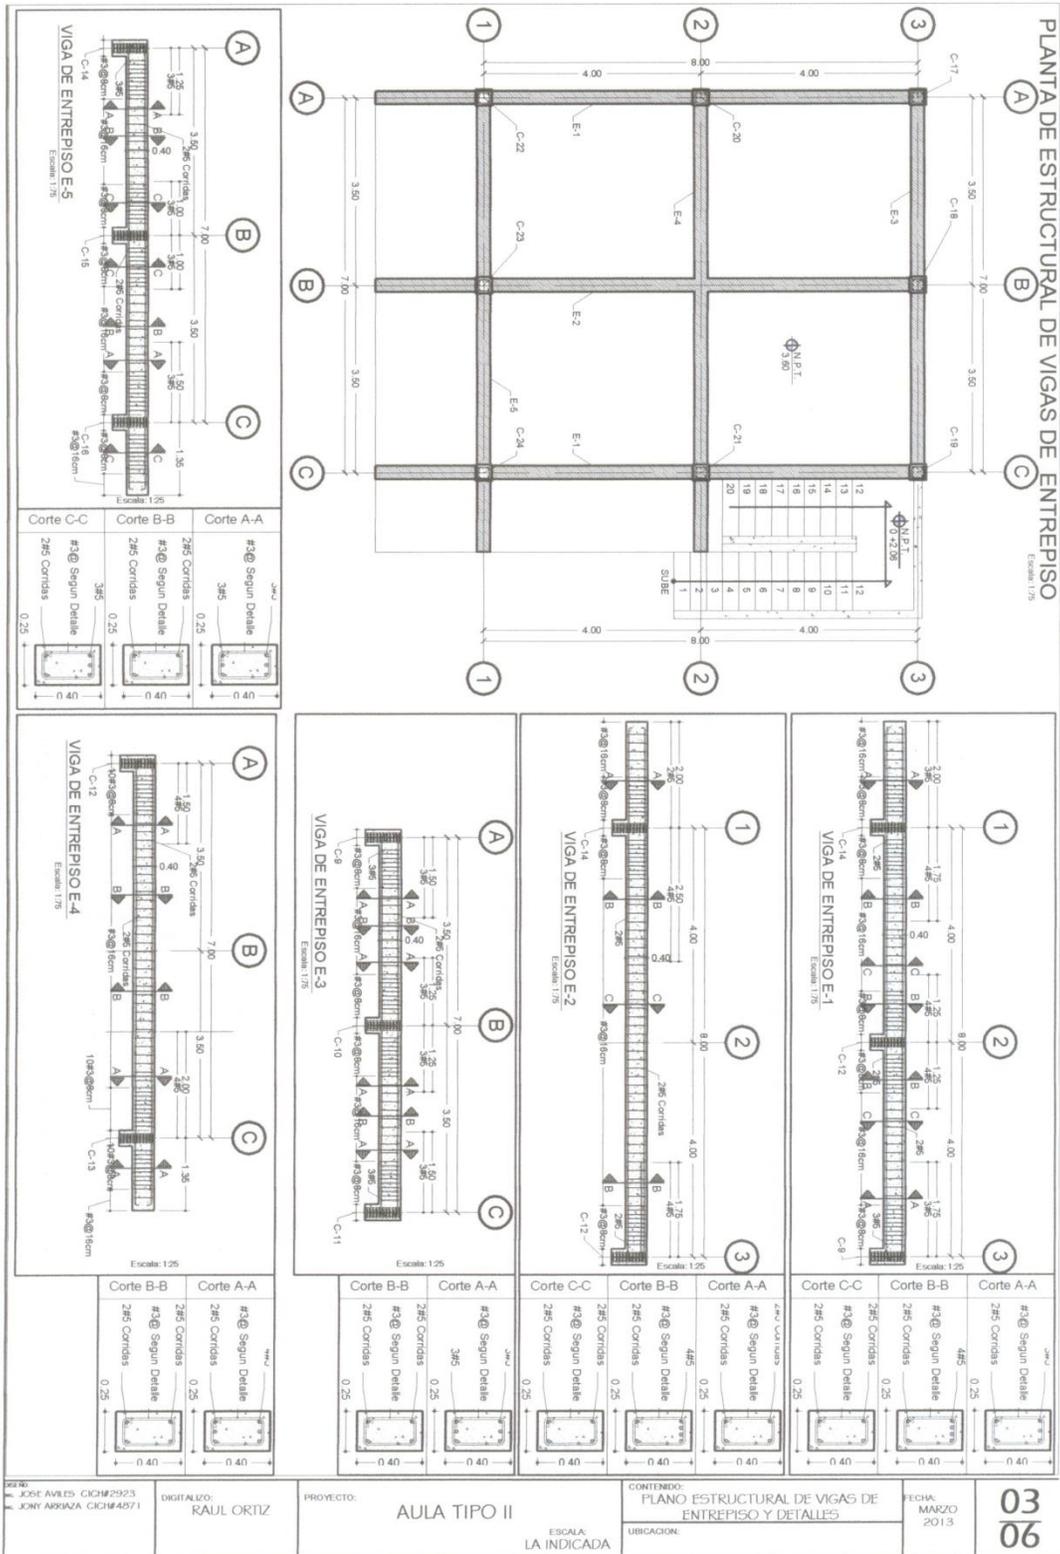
Plano de Estructural de Entrepiso Centro Escolar Aula Tipo II Niveles 7X8m
